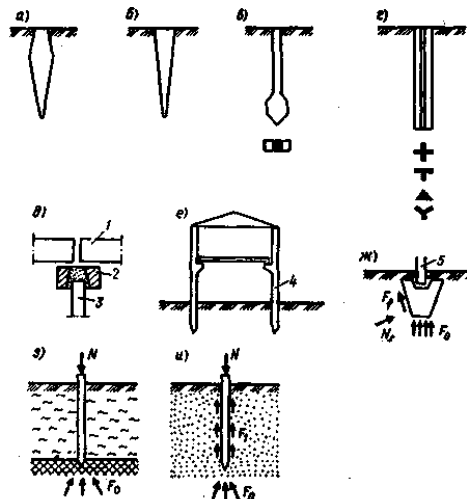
Конструкции свай: а – ромбовидные; б – пирамидальные; в – булабовидные; г – крестообразного, таврового, треугольного и трехлопастного сечений; д – безростверковый фундамент; е – свай-колонны; ж – забивные пирамидальные блоки; з – свая-стойка; и –
